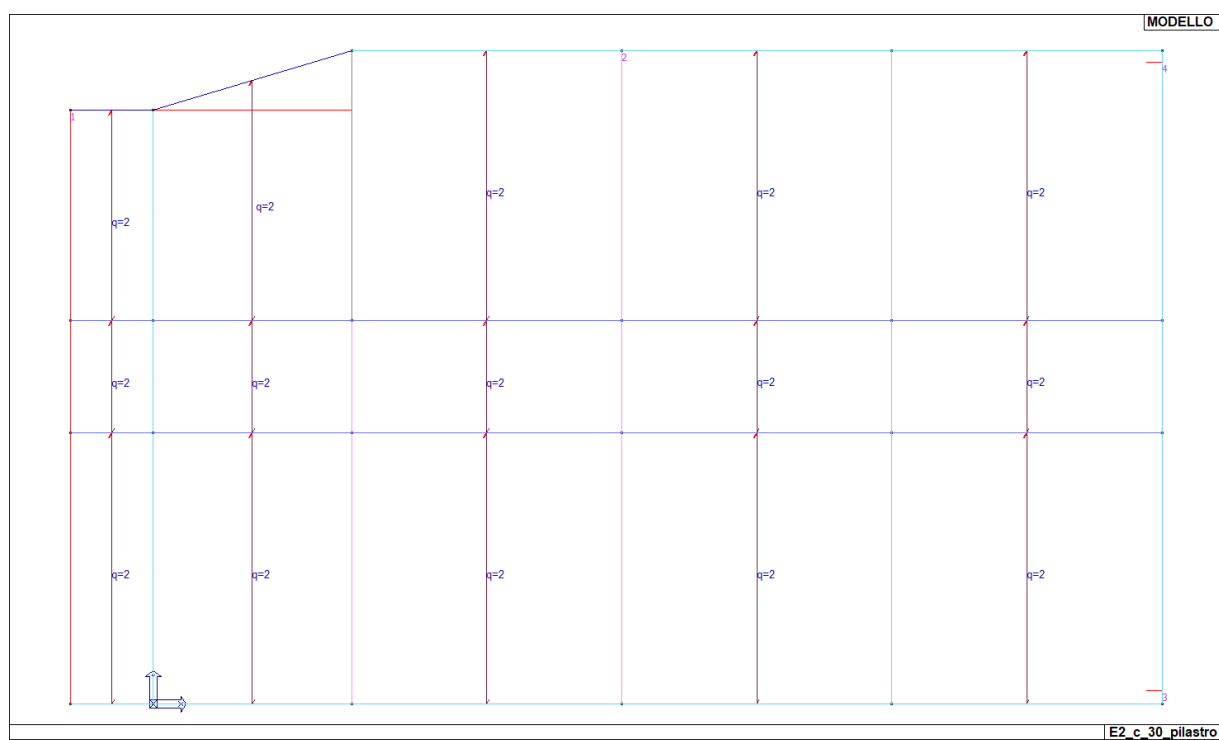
pianta solaio con indicazione tipologia solaio – pianta piano copertura
